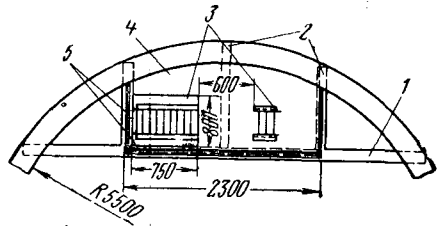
Лестничный блок вертикальный, закрепляемый в ярусах армировки:
